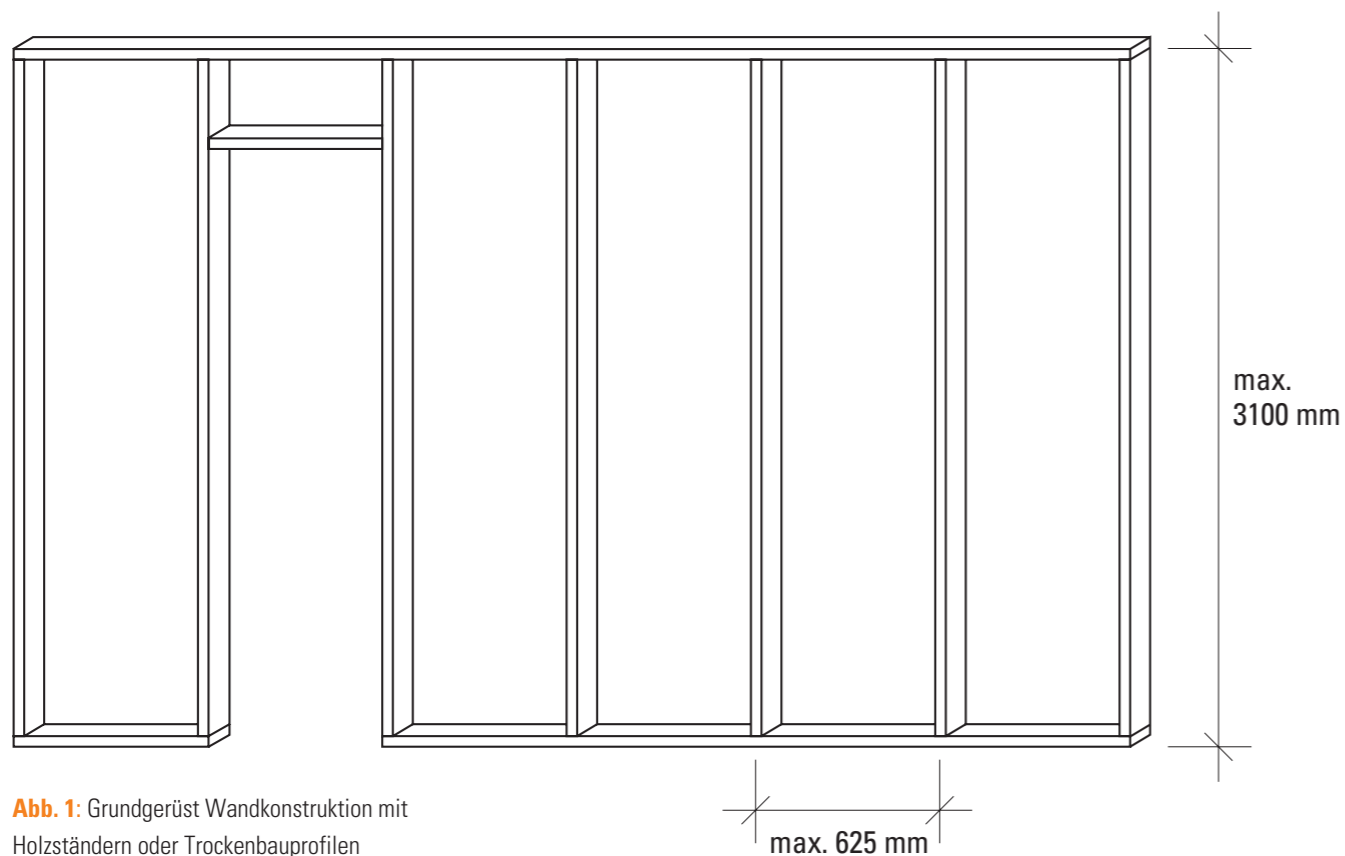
Grundgerüst Wandkonstruktion mit Holzständern oder Trockenbauprofilen
